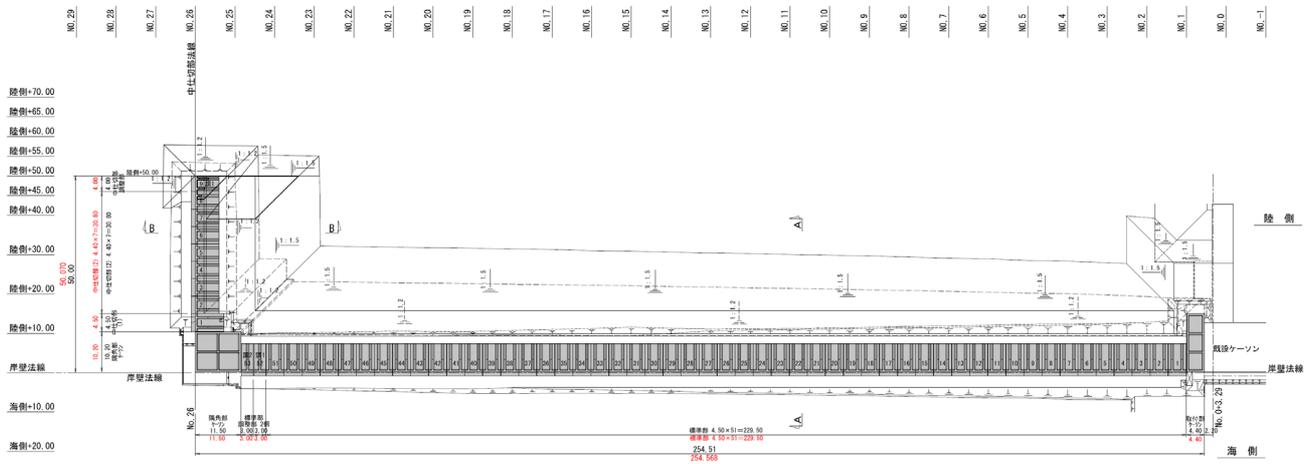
No.3 常陸那珂港区_中央ふ頭地区岸壁 (-9m)の平面図 (被災前)
